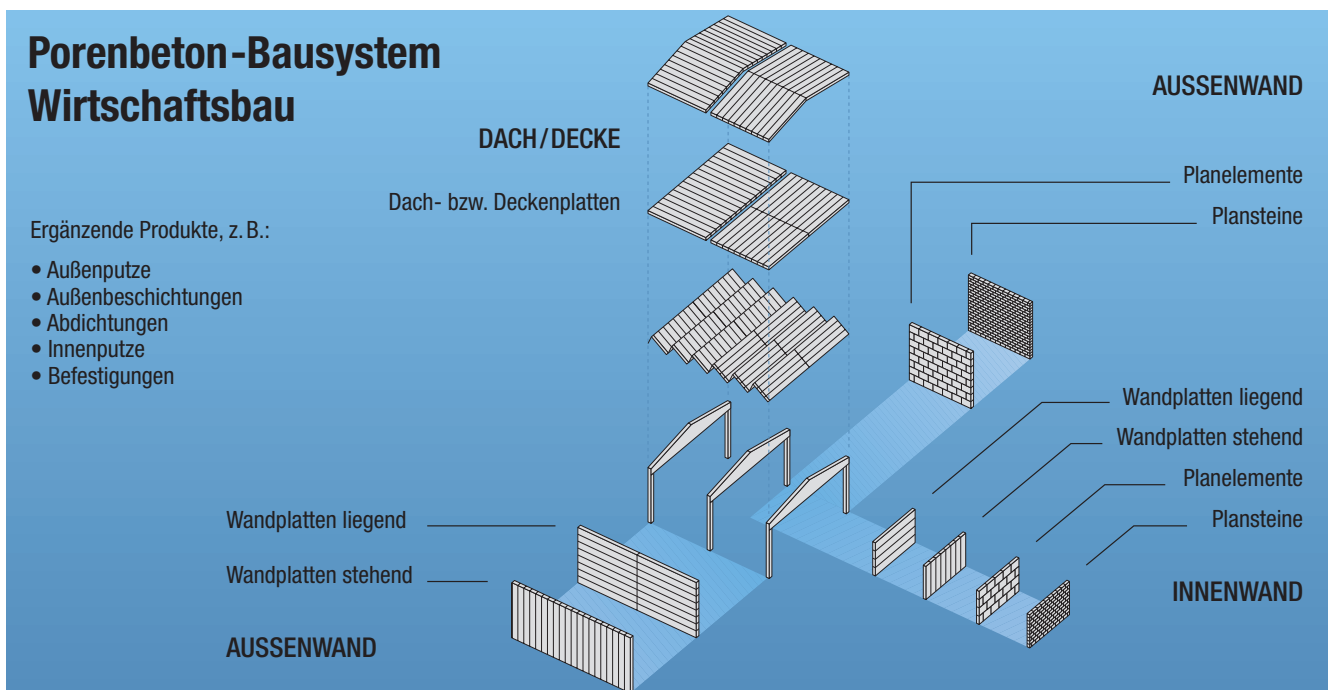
Porenbeton-Bausystem Wirtschaftsbau
